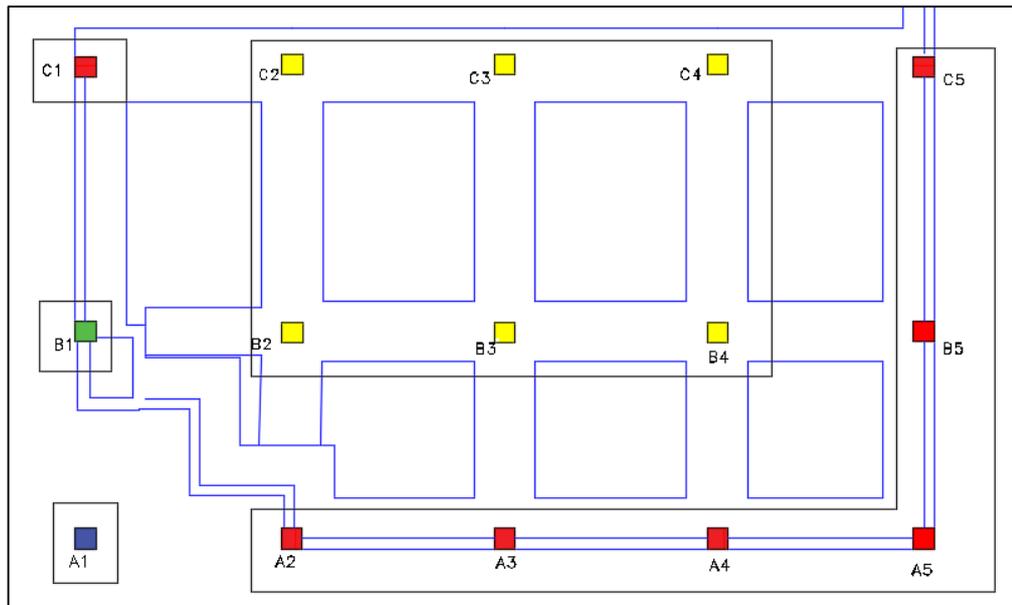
Esquema de distribución de tipos de columnas (Acero)
